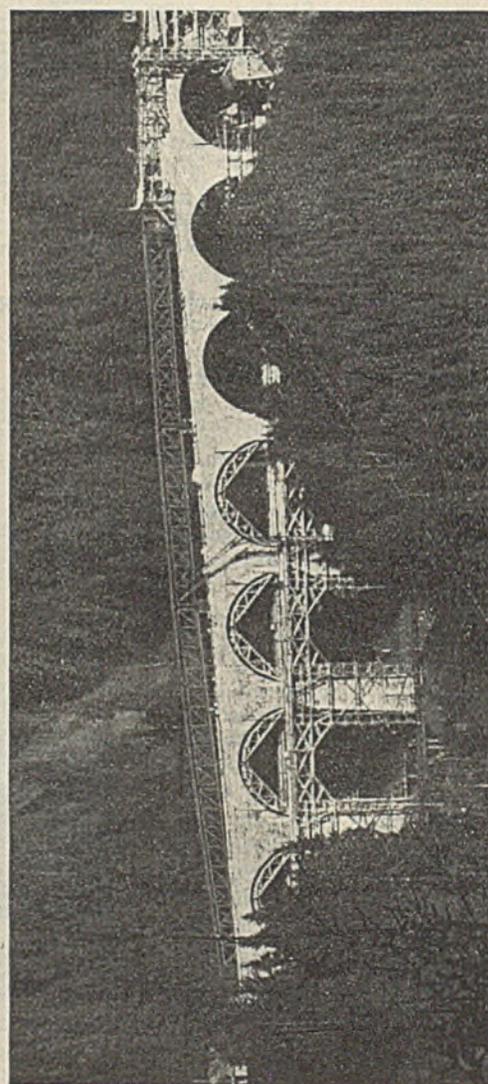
Neuer Ravennaviadukt, im Hintergrunde der alte Viadukt.
